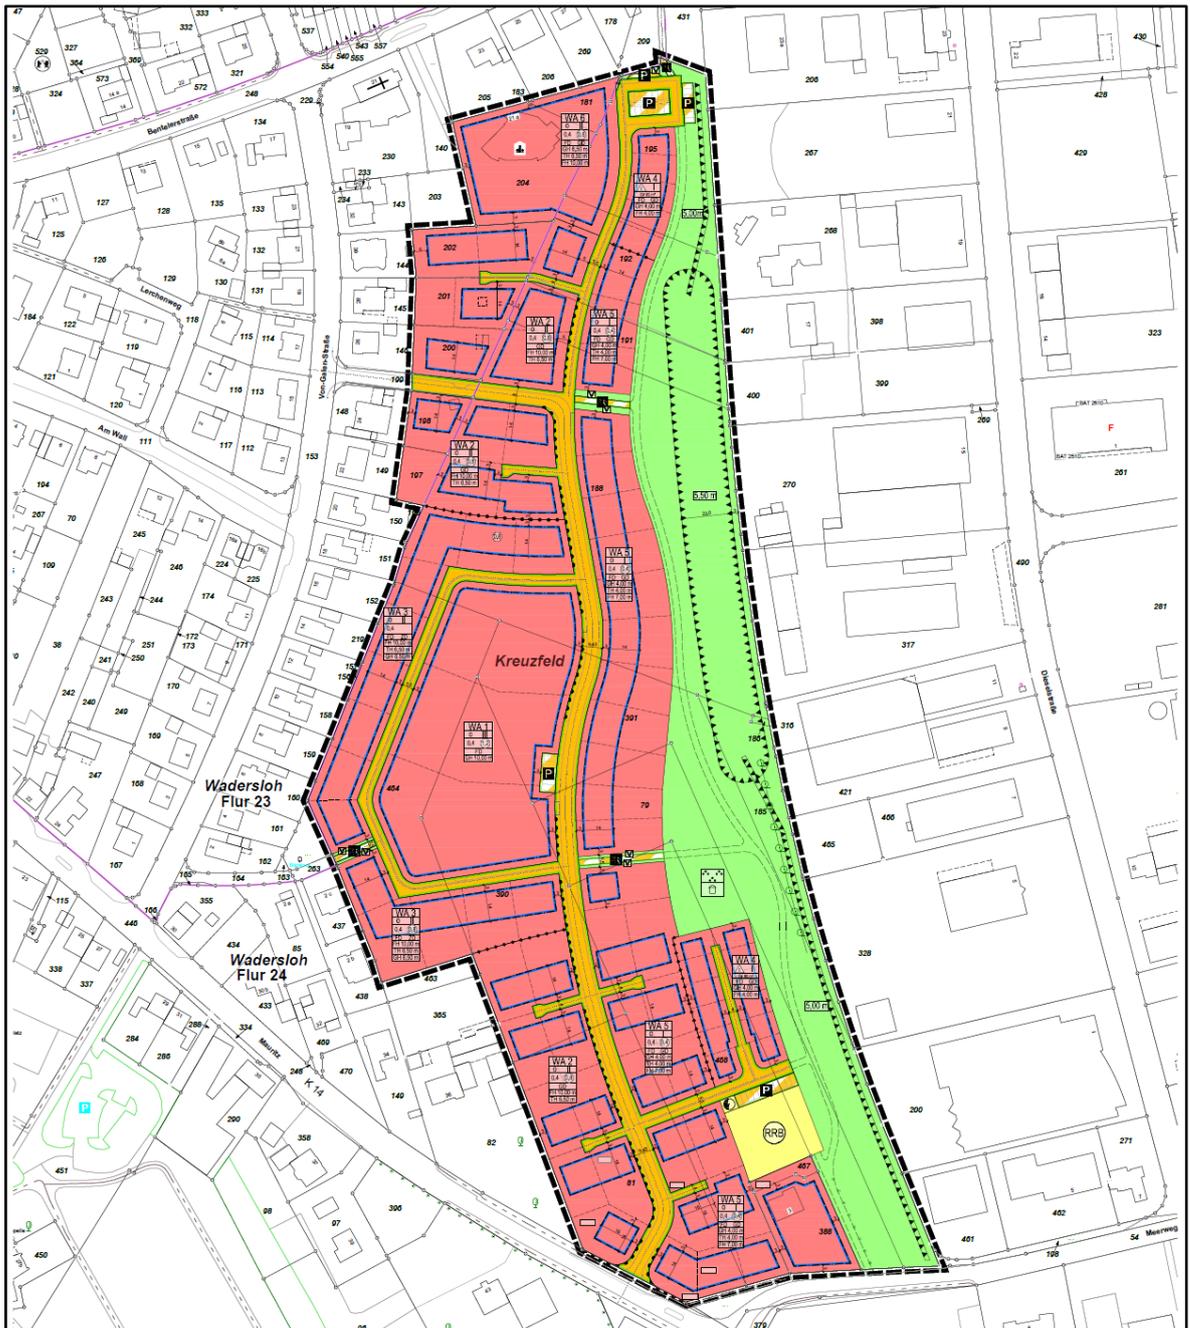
Ausschnitt aus dem Entwurf des Bebauungsplan Nr. 71 [9]
